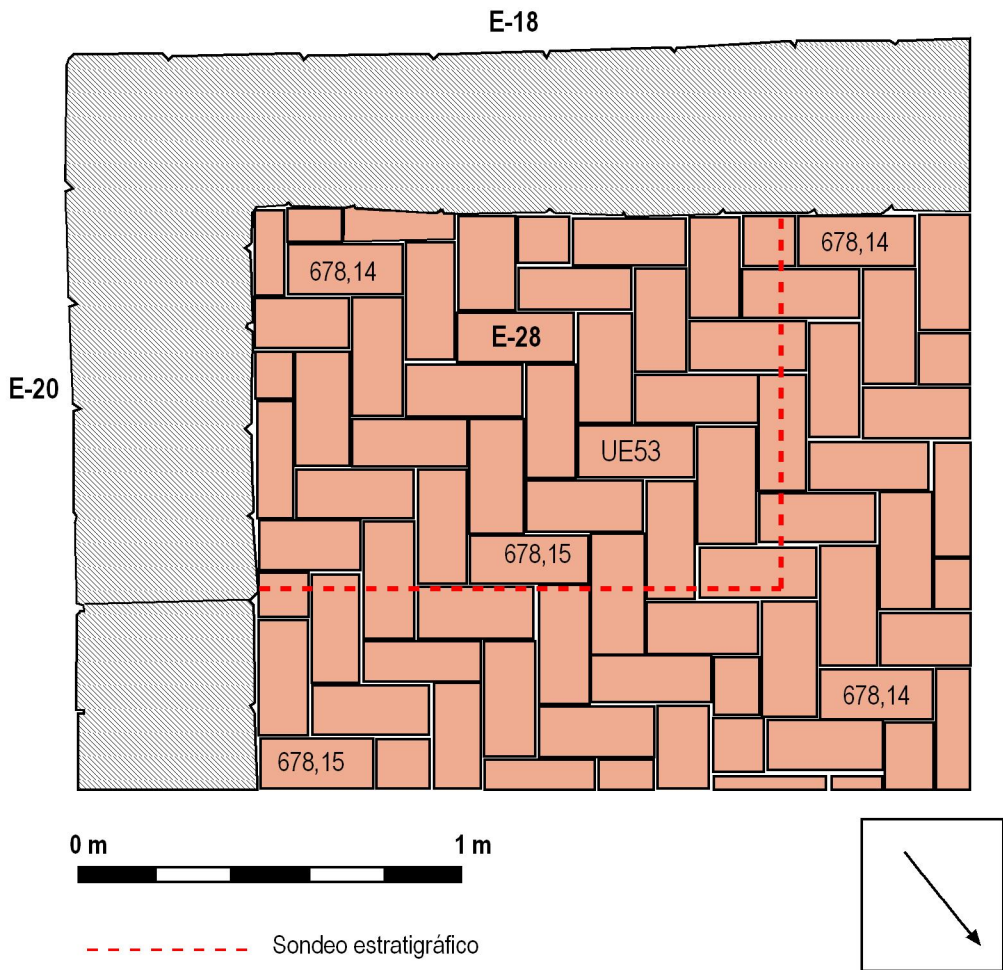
Planta Baja. Sondeo 1. Planta de inicio de sondeo estratigráfico. Pavimento de losetas de barro colocadas a la palma simple a hueso.
